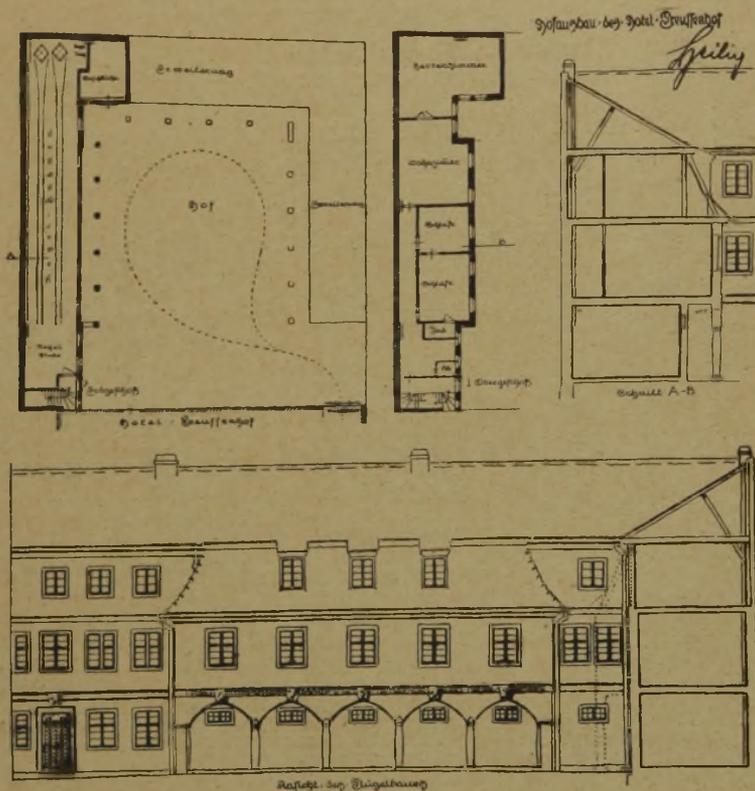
Lageplan, Grundriß, Schnitte zum Preußenhof, Prenzlau.
